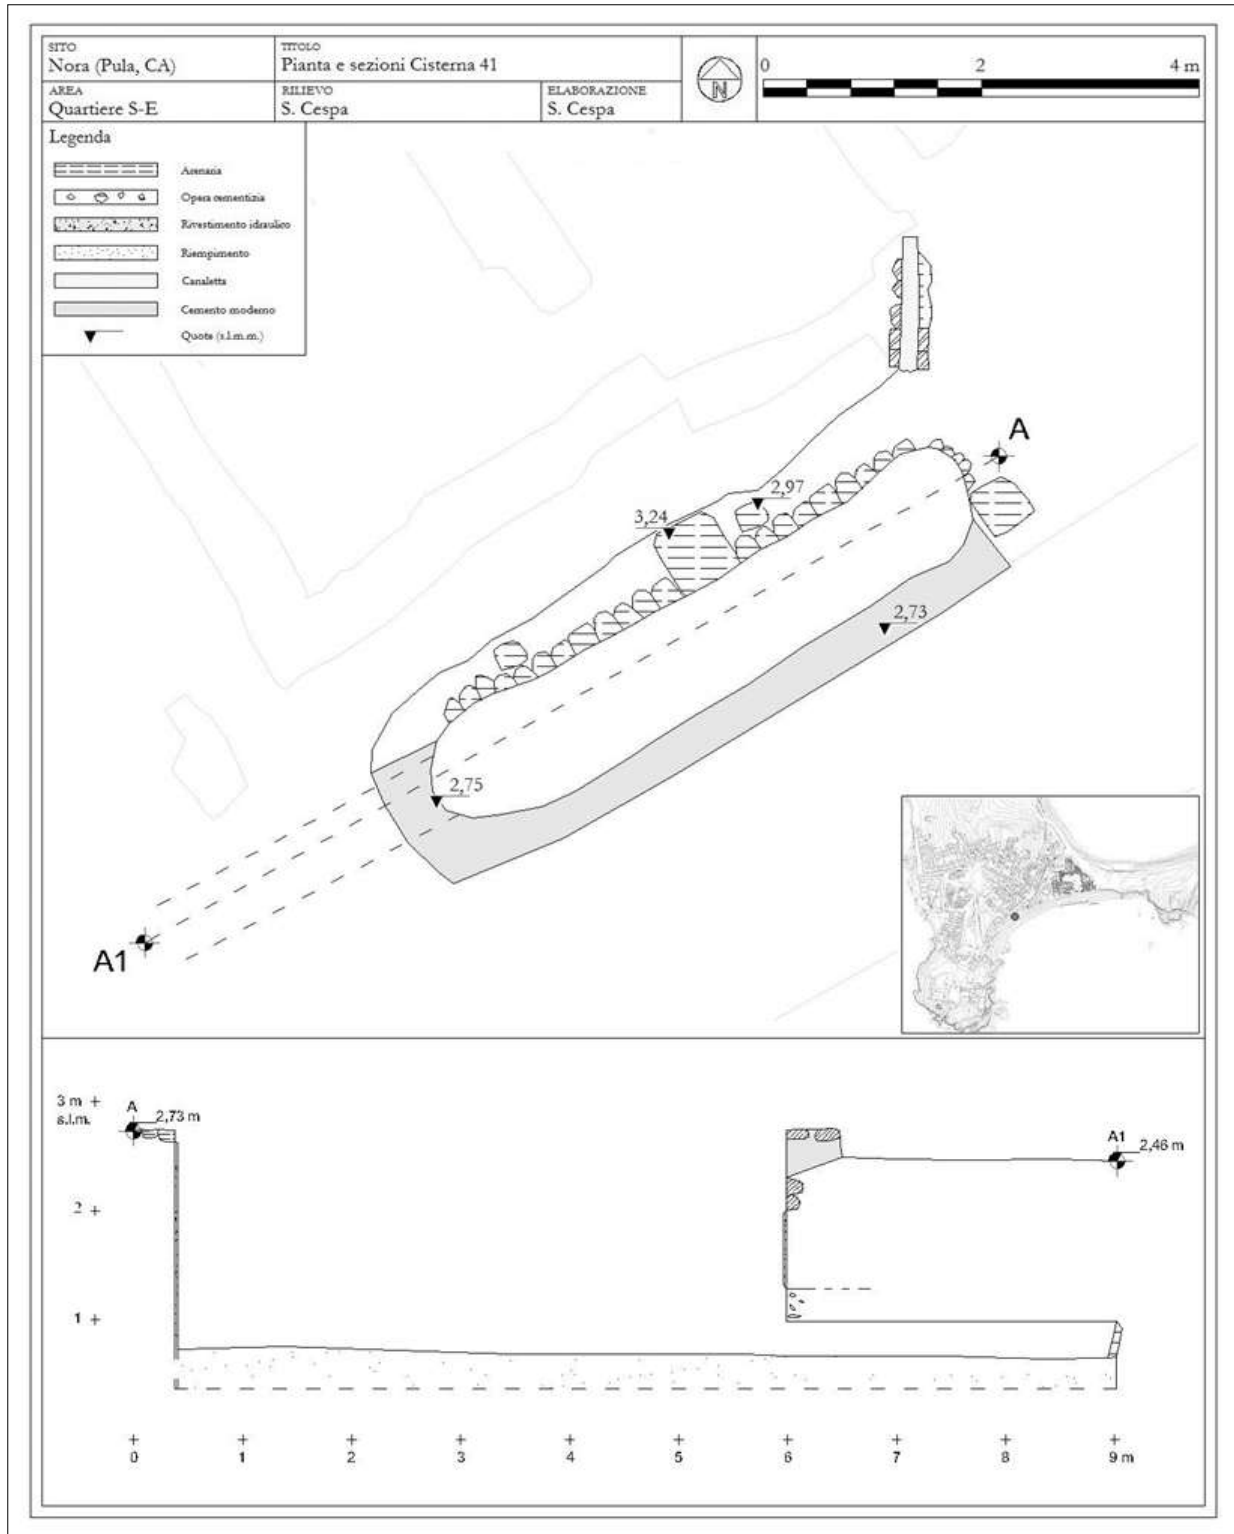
Pianta e sezione della cisterna 41 (elaborazione dell'autore).
